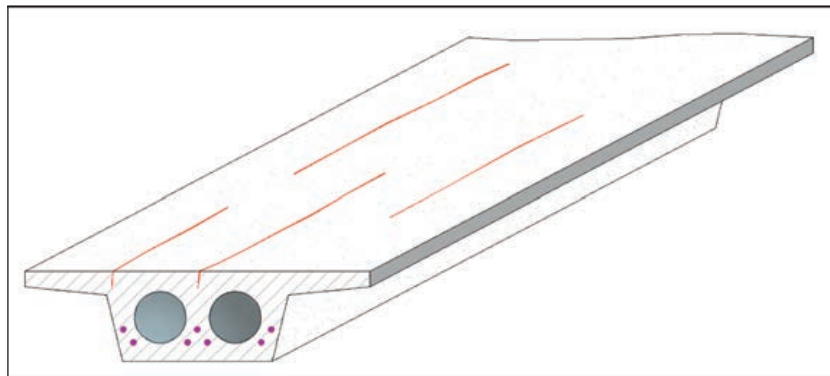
FISURAS LONGITUDINALES EN EL PLANO MEDIO DE LAS ALMAS POR ASIENTO PLÁSTICO.
